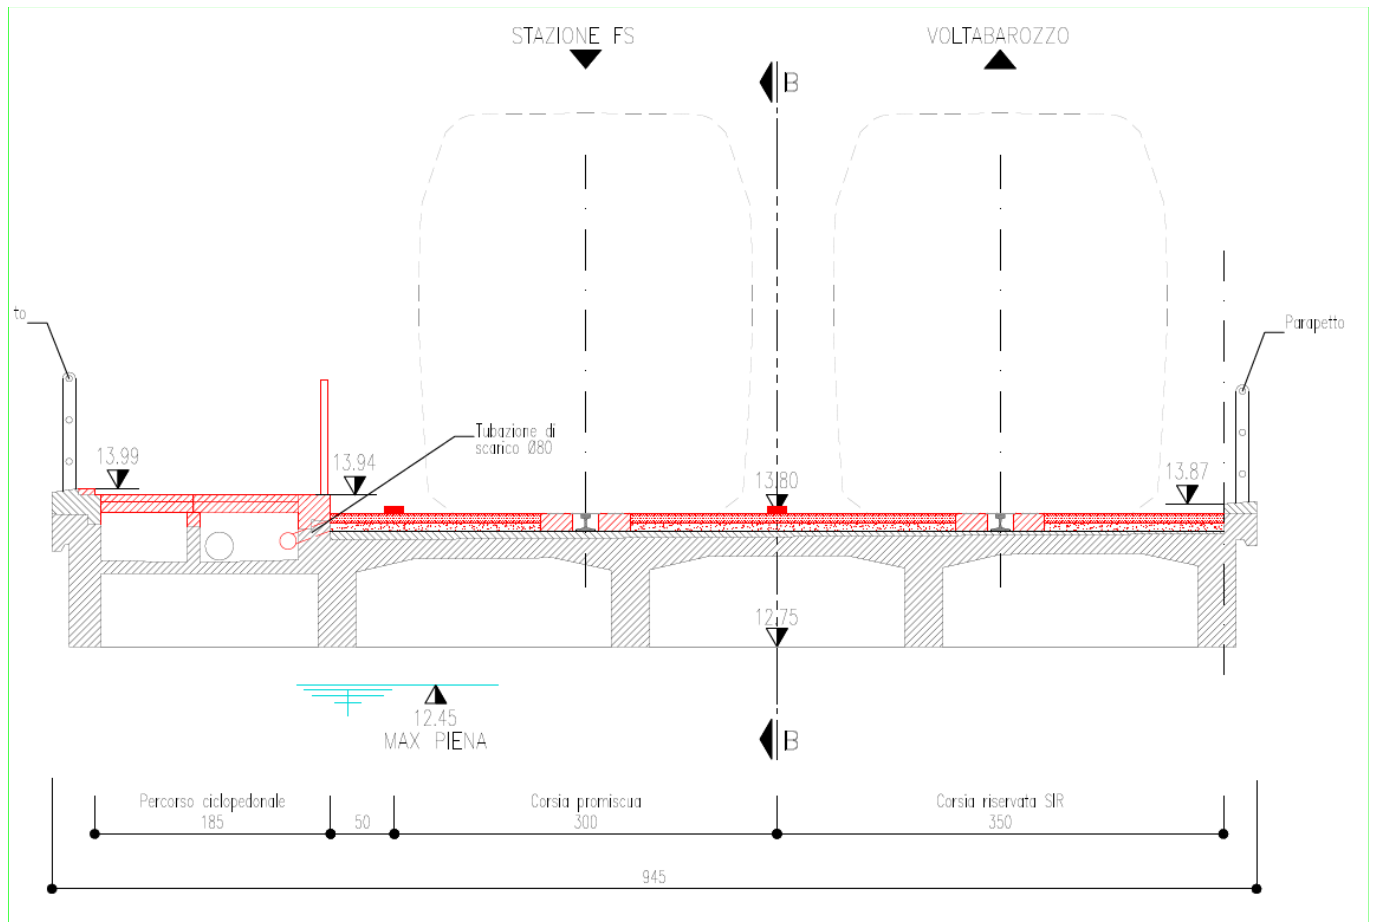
Sezione trasversale del ponte S.Omizzolo – Interventi di progetto
